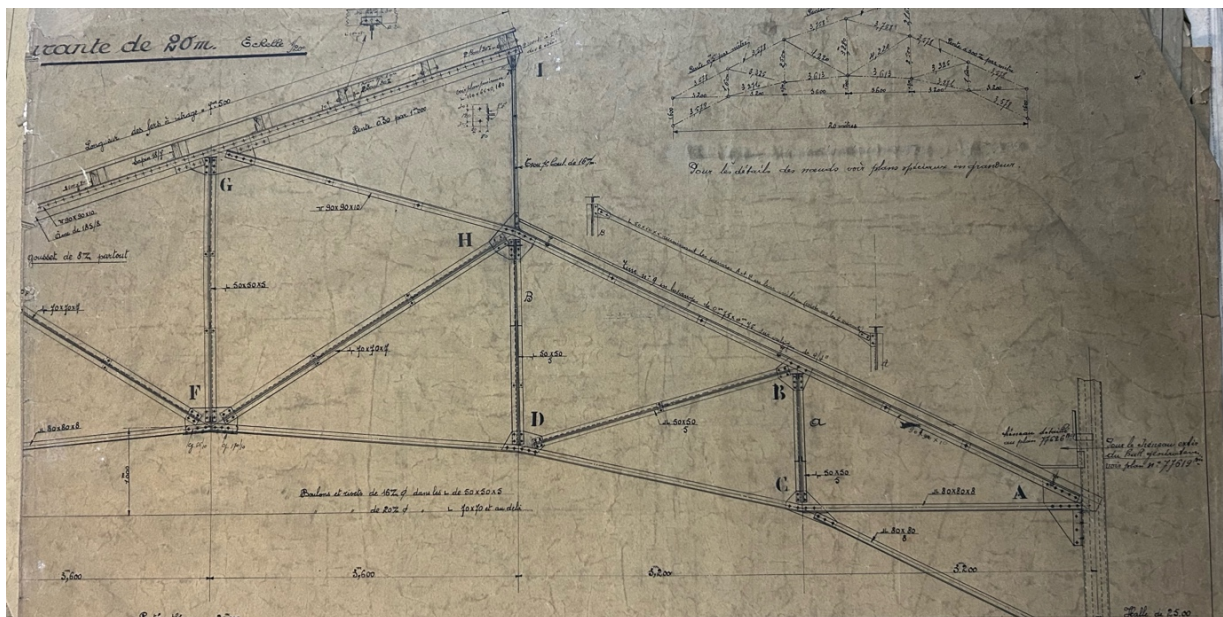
Plan en élévation d'une ferme charpente de 20m, Exposition de Bruxelles 1910
